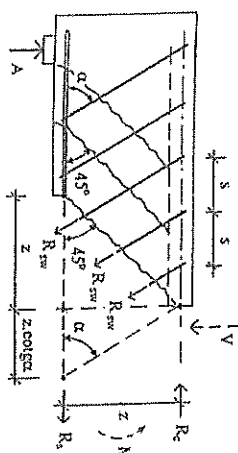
Elemento de viga junto a um dos apoios delimitado pela fissura oblíqua
